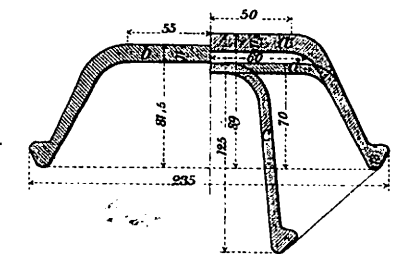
Oberbau für Nebenbahnen mit hölzernen Querschwellen. (1:2 d. nat. Gr.)
